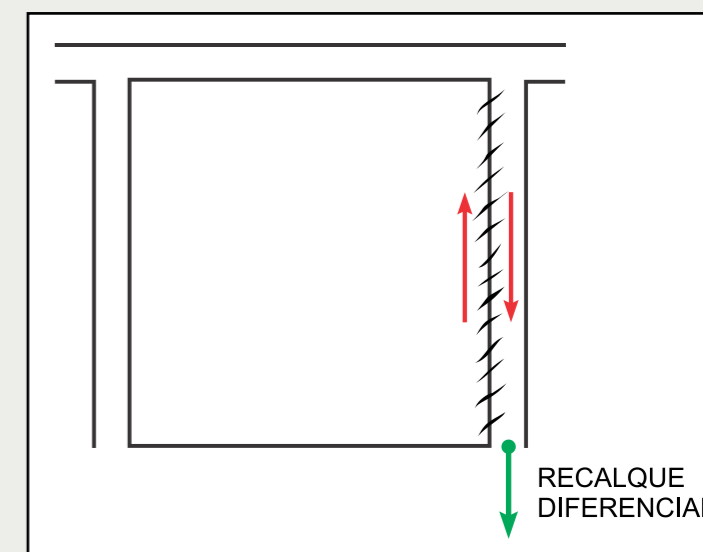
Tensões tangenciais entre pilar e parede (deslizamento).
